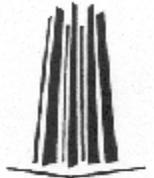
CIMENTACIÓN MEDIANTE PILAS
